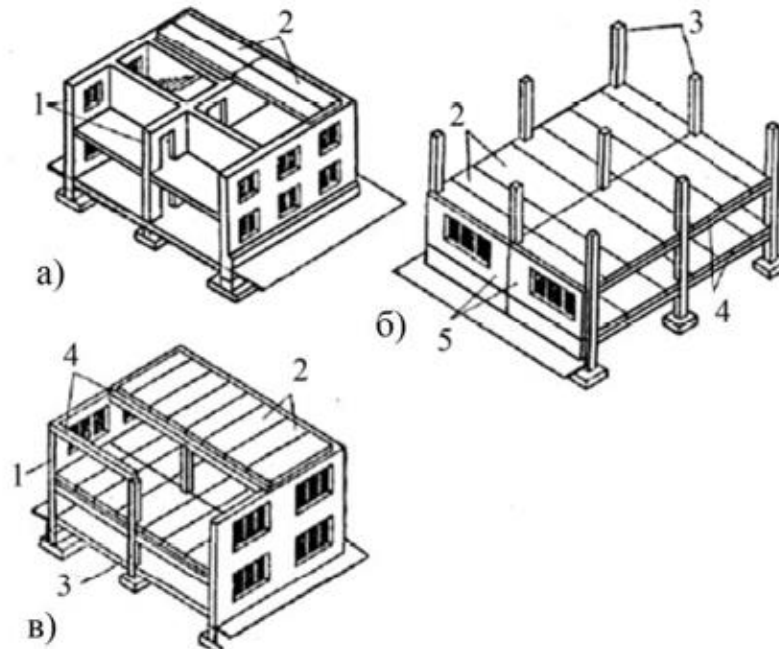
Конструктивні типи громадських будівель: а) безкаркасний; б) каркасний; в) неповний каркасний; 1 – несучі стіни; 2 – міжповерхові перекриття; 3 – колони; 4 – ригелі; 5 – самонесучі стіни
